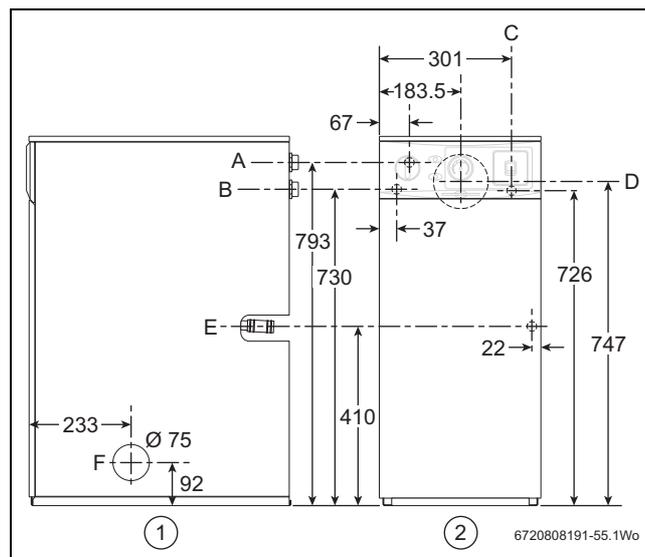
Positions de la conduite (toutes les dimensions en mm)
